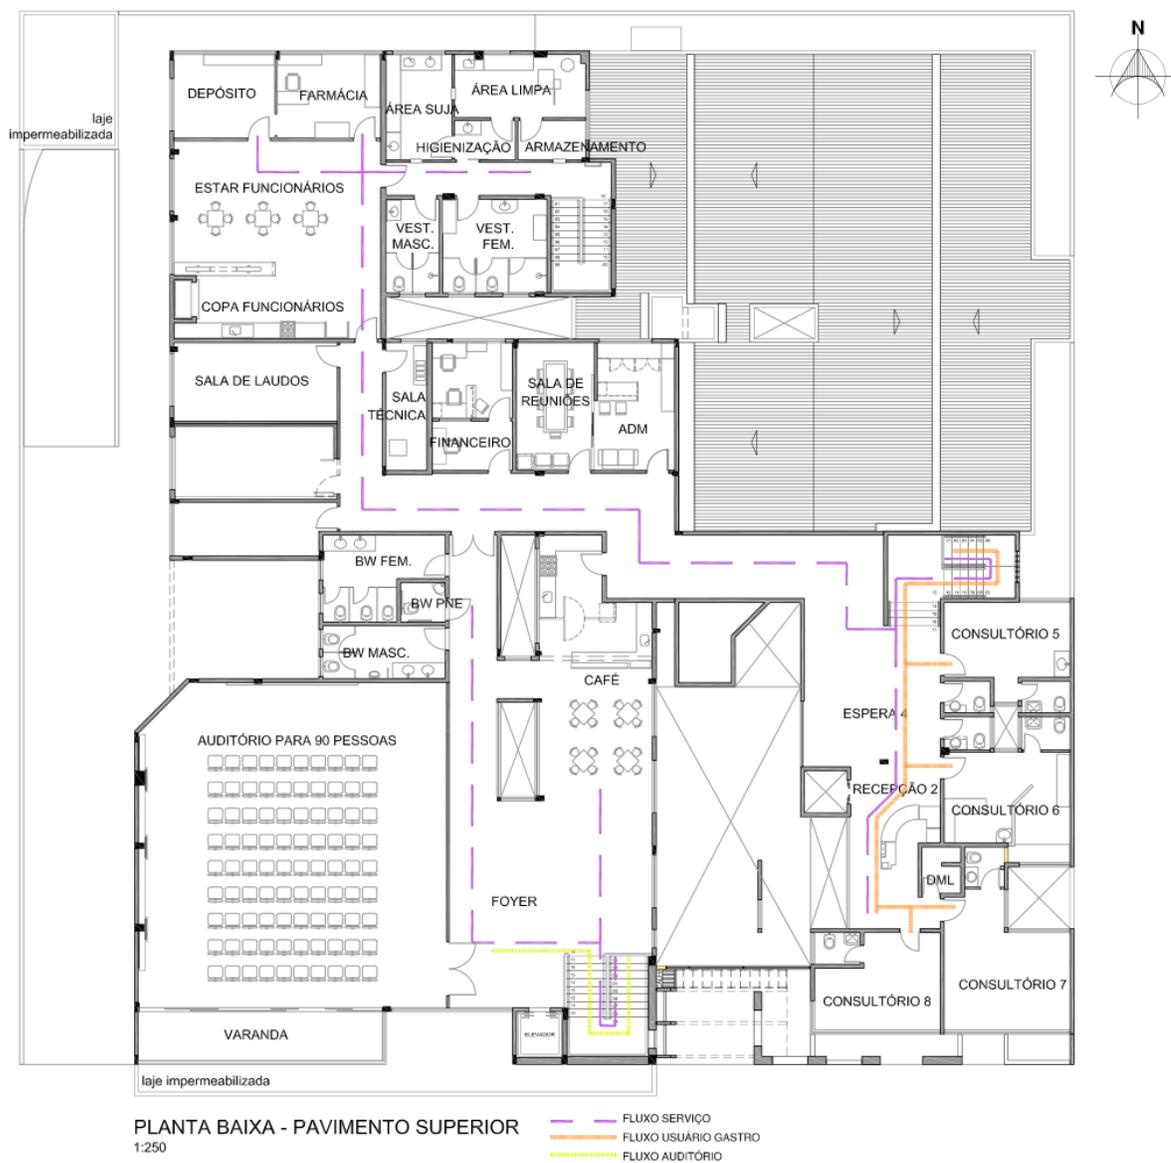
Planta do pavimento superior do IGAST, Toledo PR.
